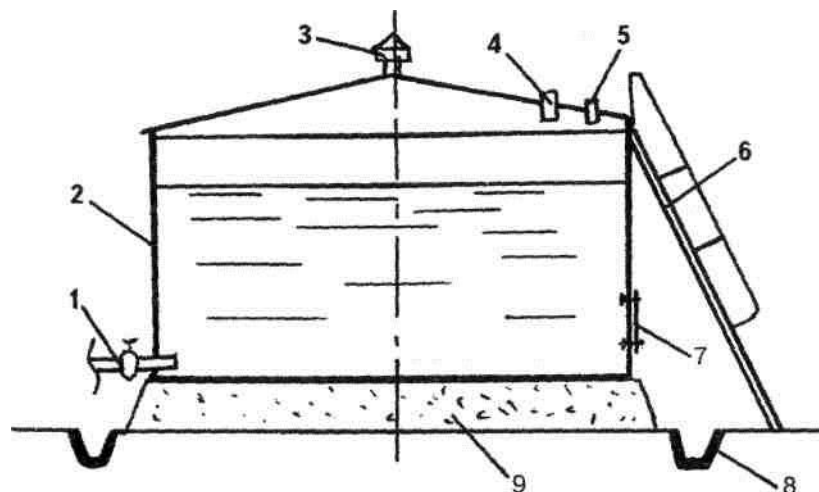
Металлический цилиндрический вертикальный резервуар для светлых нефтепродуктов:
